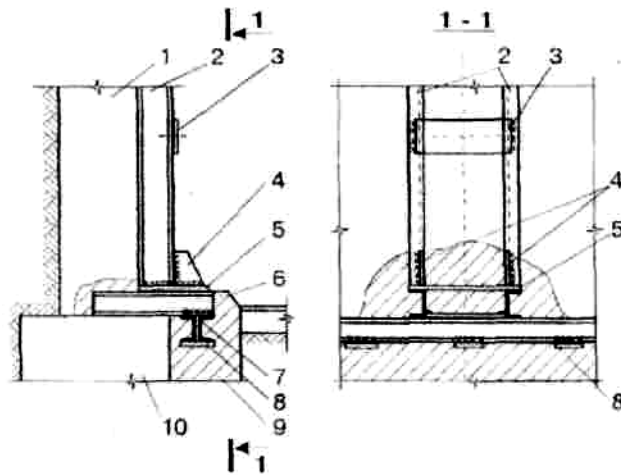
Схема опирання металевої стійки підсилення на фундамент:
